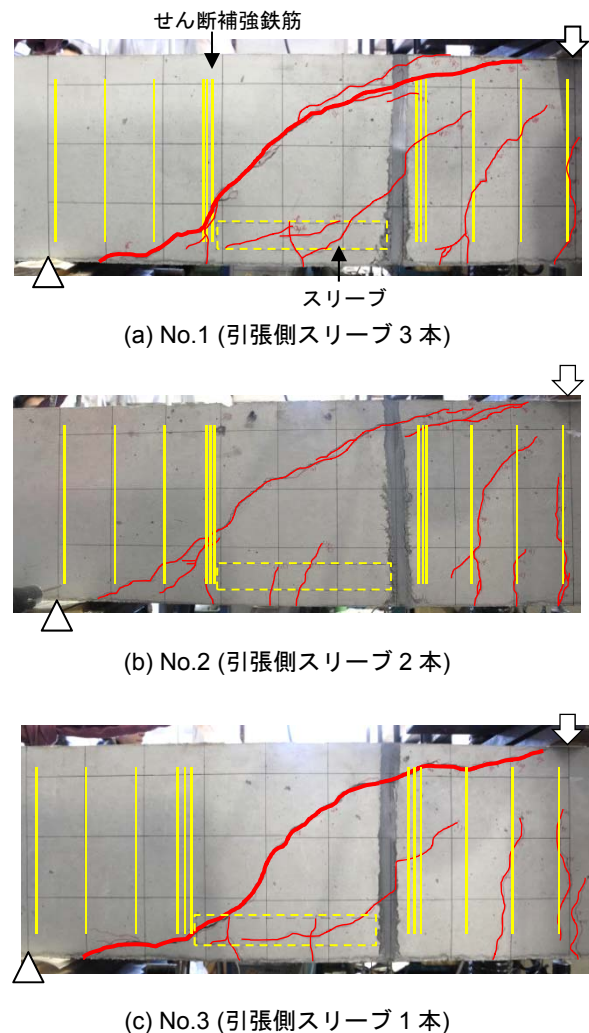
最大荷重時のひび割れ性状 (No.1, No.2, No.3)
